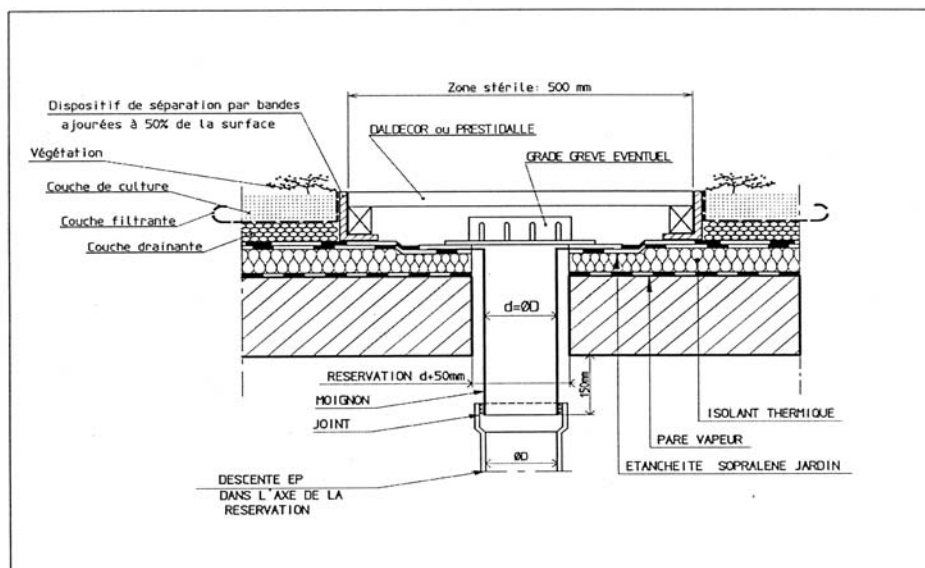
Exemple d'évacuation pluviale avec zone stérile en dalles bois
